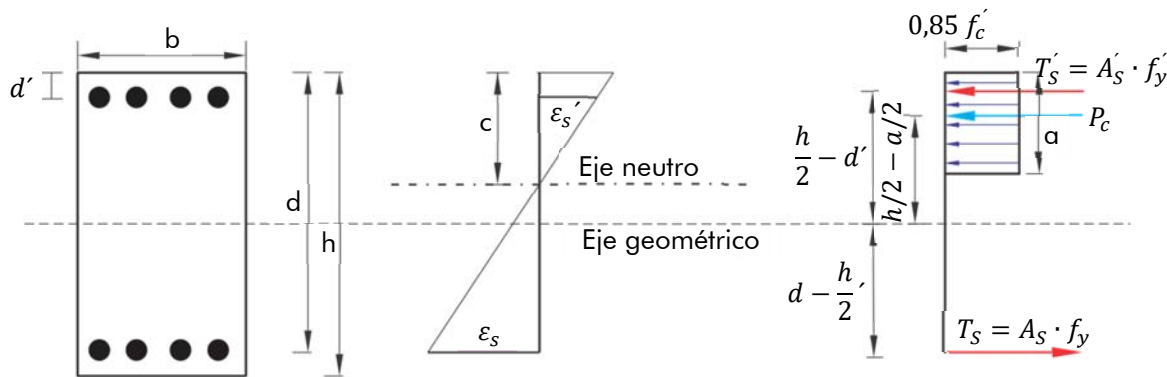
Estado tensional de una sección de hormigón armado sometida a flexocompresión
